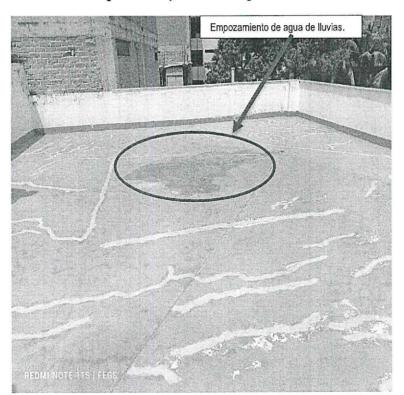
Fisuras resanadas en el techo de la infraestructura
